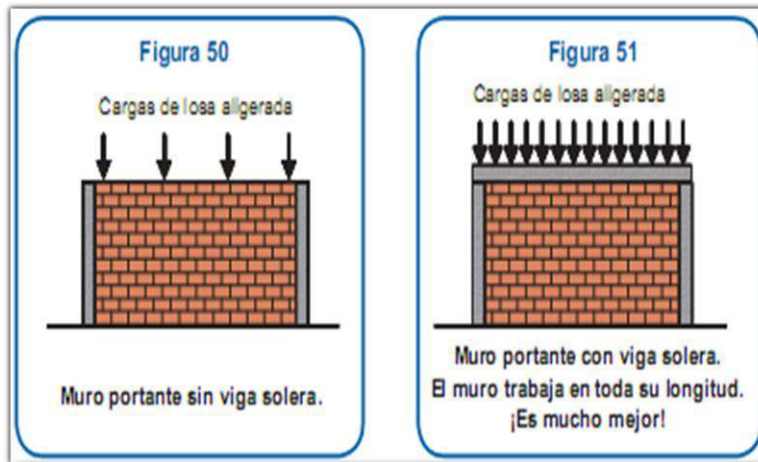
Comportamiento de las cargas según la aplicación de viga.
